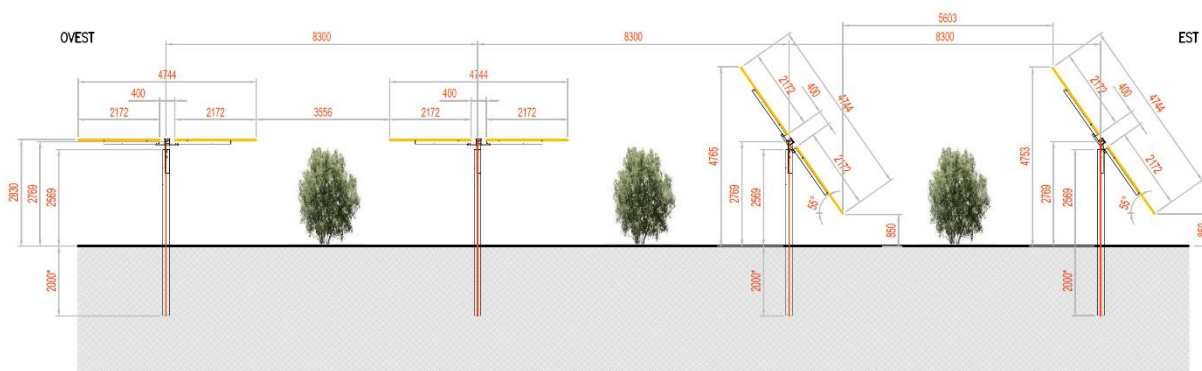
Tipologico - Vista in sezione dell'impianto olivicolo
